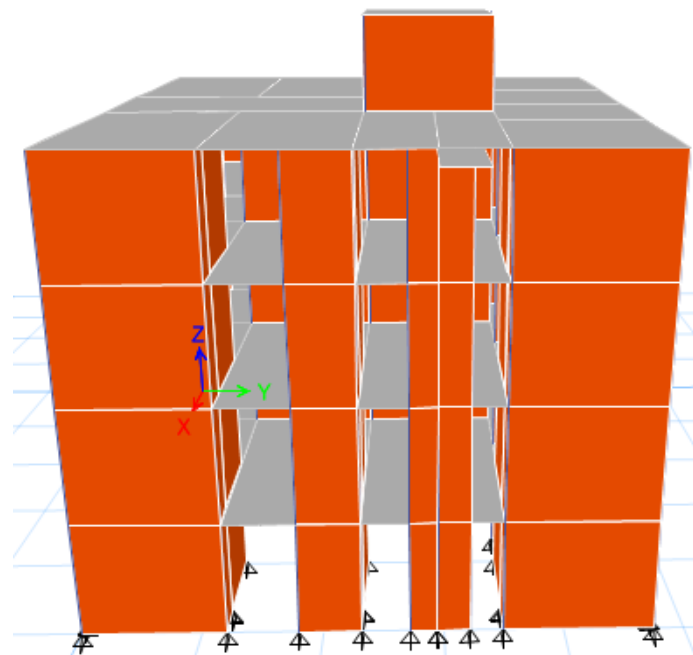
Vista elevación lateral Eje “Y” (Fuente: Elaboración propia).
